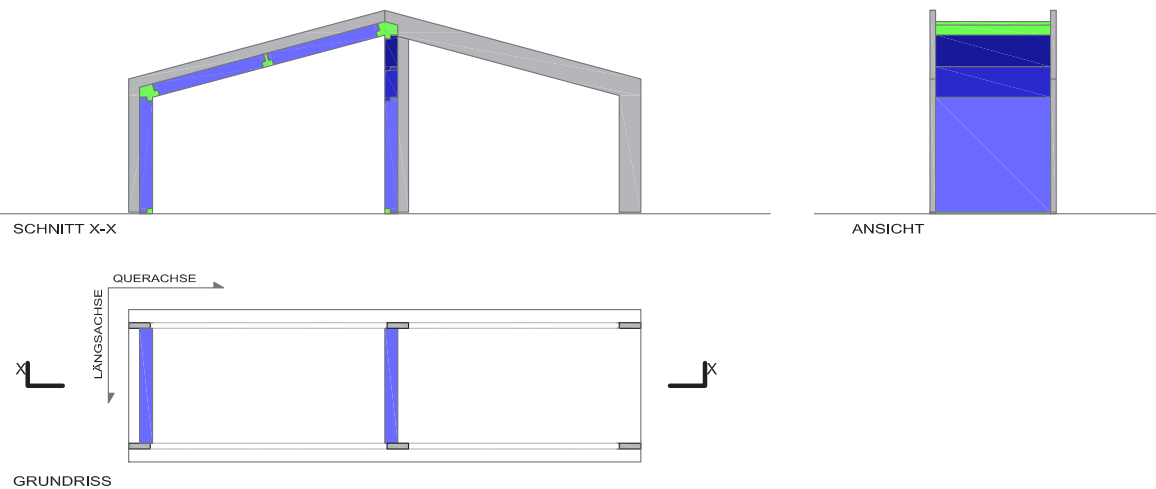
| Systemgrundriss mit Wandversatz (First), Schnitt und Ansicht
